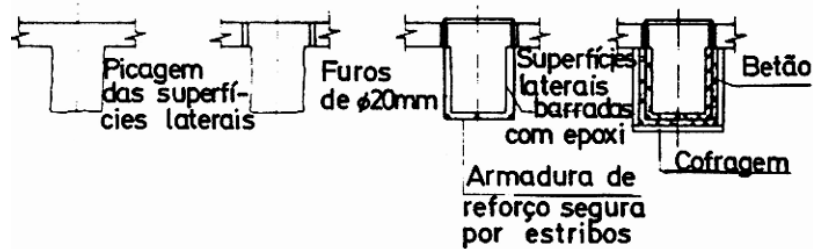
Reforço de uma viga à flexão com recurso a nova armadura embebida na laje pré-existente (12).
